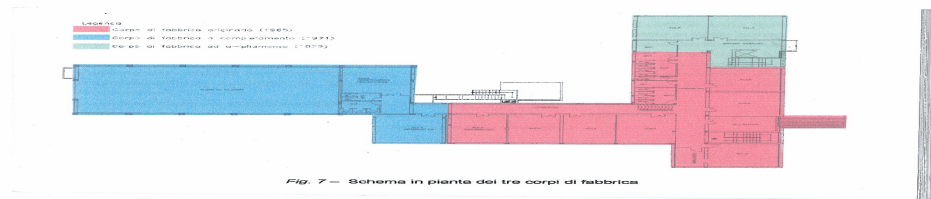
Schema in pianta dei tre corpi di fabbrica
